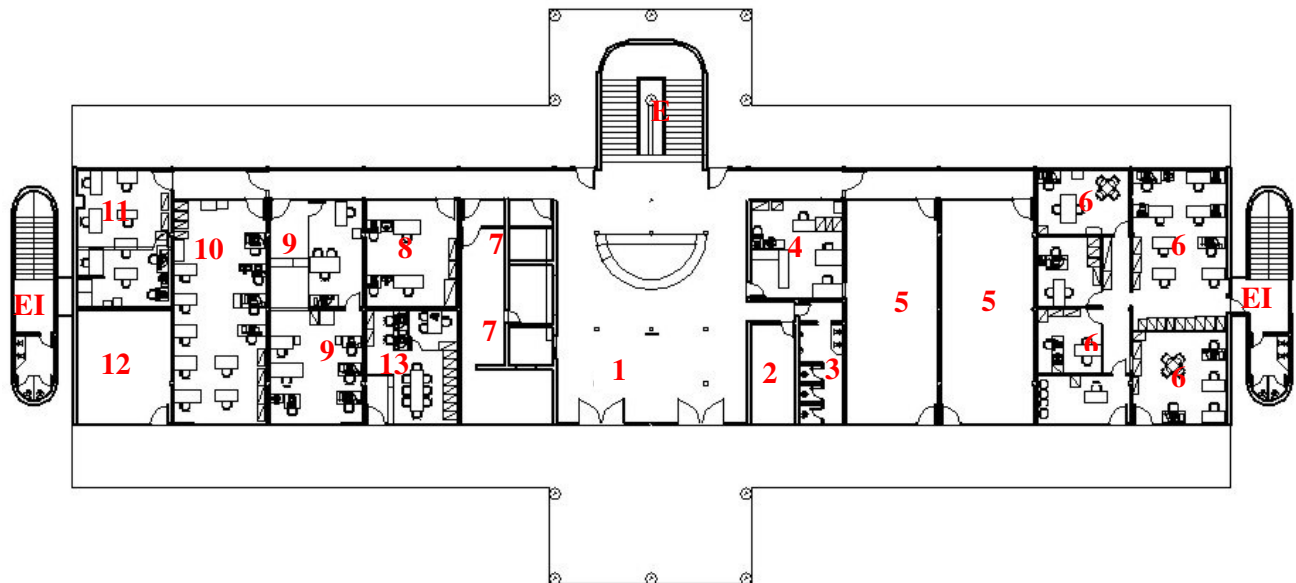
Prefeitura Municipal de Mariana – Pavimento Térreo – Planta Baixa.
